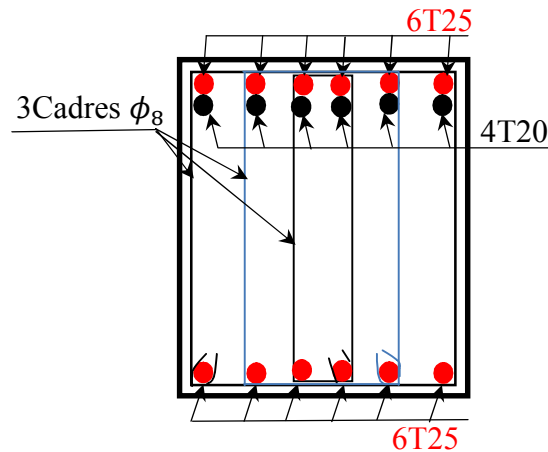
Schéma de ferrailage de la poutre de rigidité.
